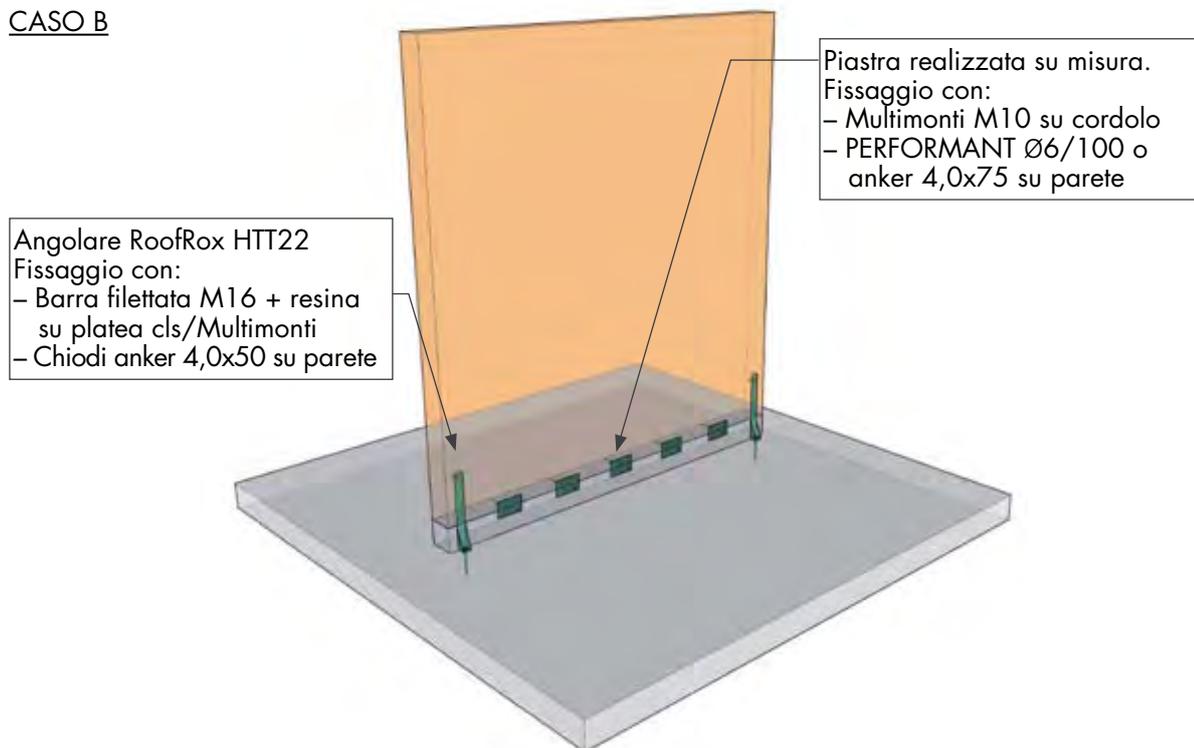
Fissaggio parete a terra con cordolo di rialzo
